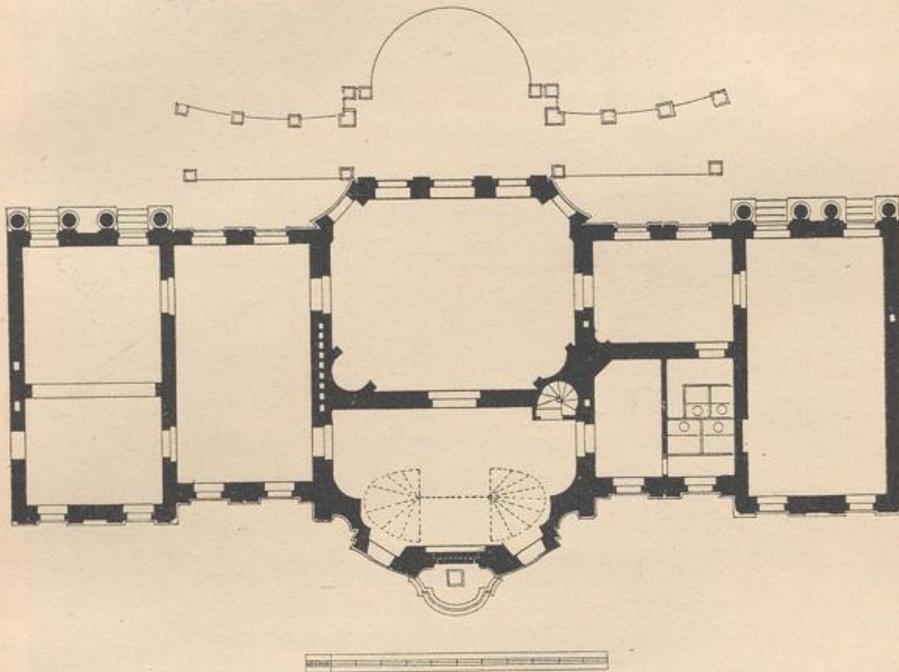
Kamefe'sches Gartenhaus zu Berlin. Grundriß.
